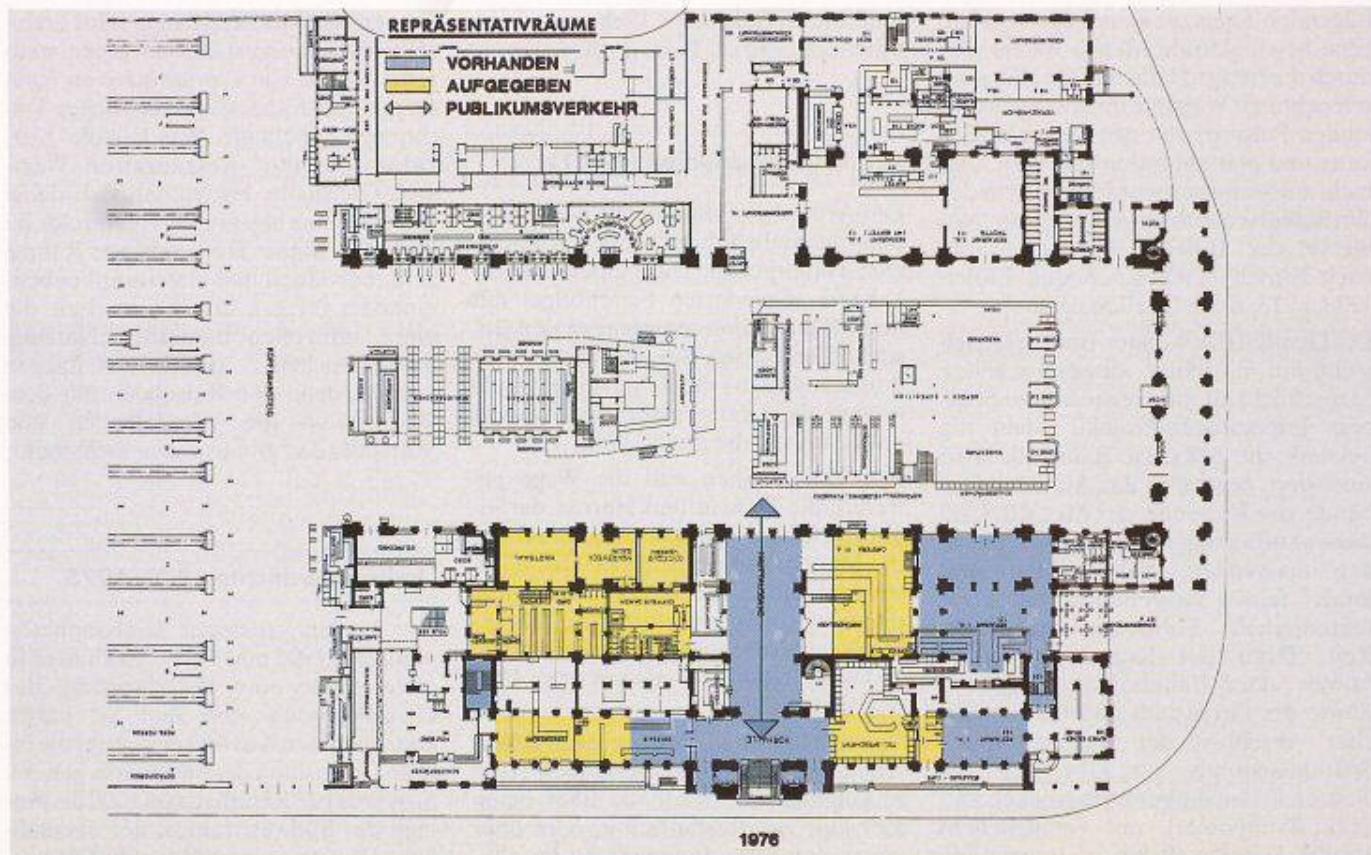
Zustandsplan 1976 (Grundriss Erdgeschoss). Das traurige Schicksal der ehemaligen Repräsentativräume
